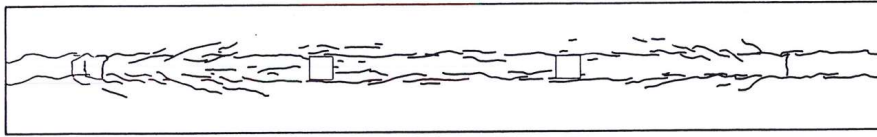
Profil de fissuration de la poutre 4 testée par (Badawy et Bachman, 1977)
